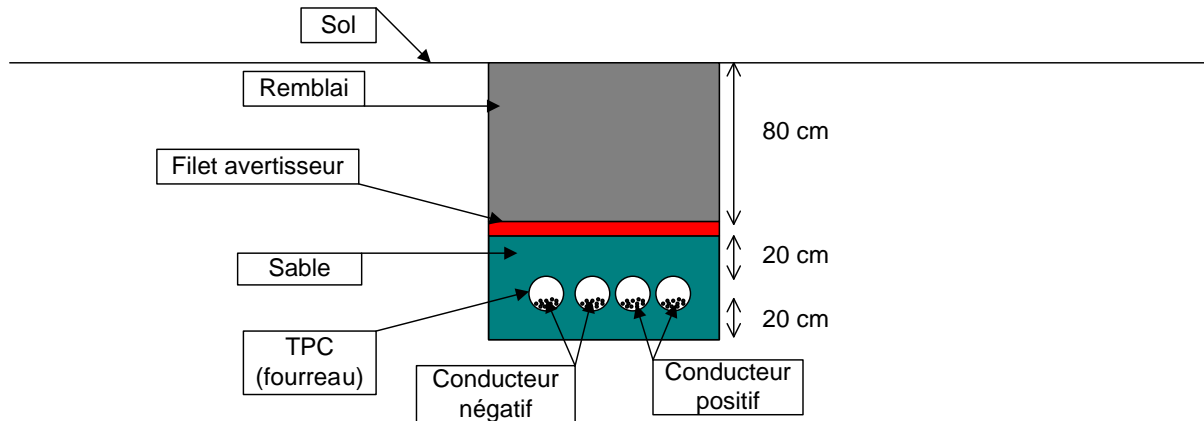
SCHEMA DE COUPE DES PASSAGES DE CABLES SOUTERRAINS
